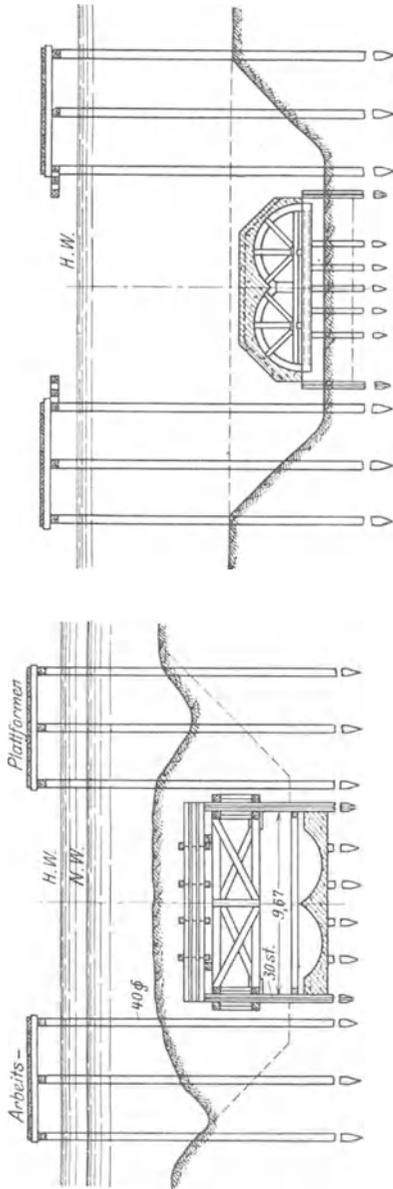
Bauausführung des Harlem-River-Tunnels im Zuge der Newyorker Untergrundbahn.
